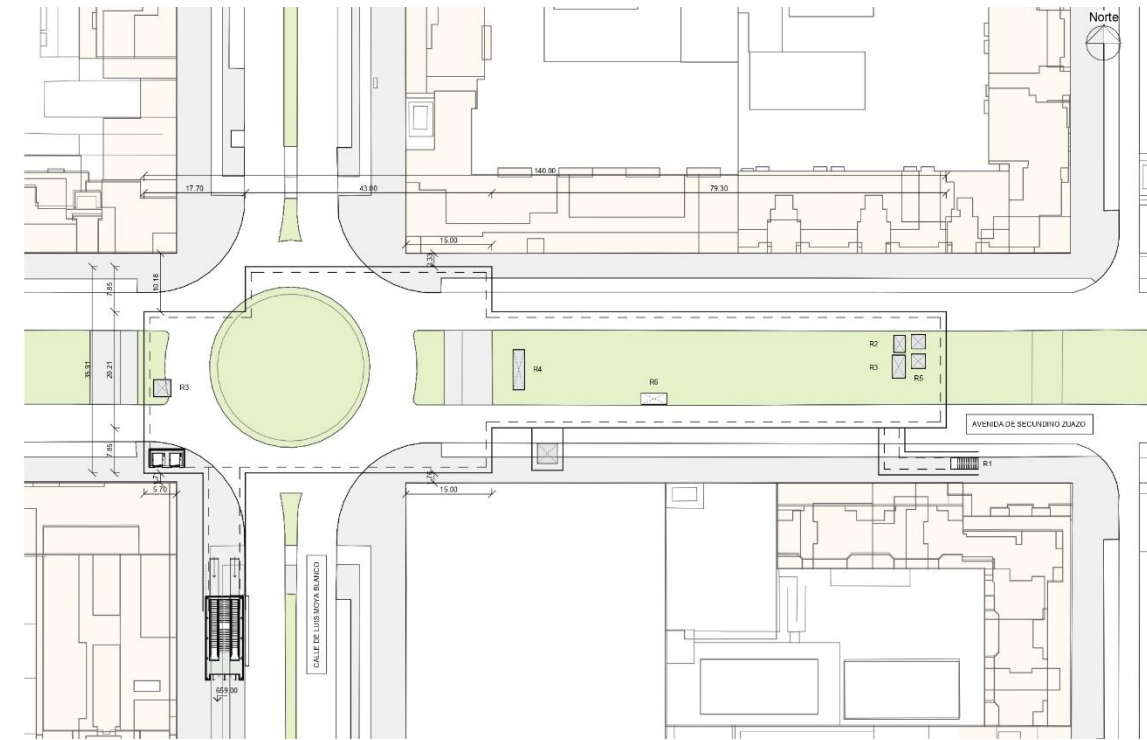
Estación Valdebebas Norte _Planta Calle
